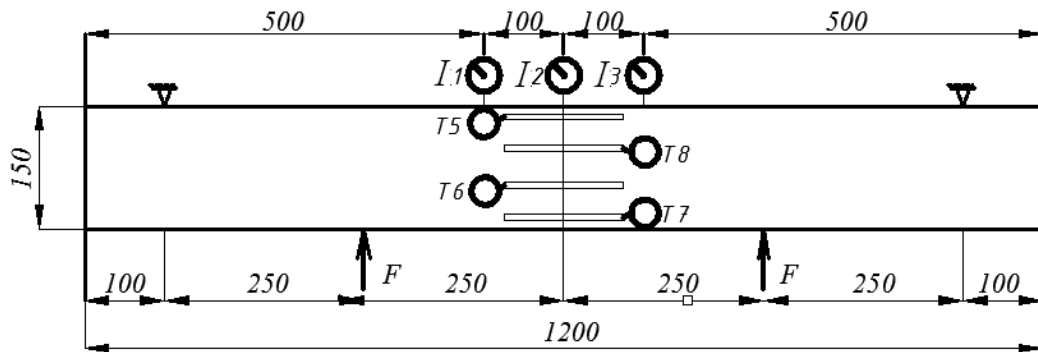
Схема завантаження залізобетонної балки-зразка
